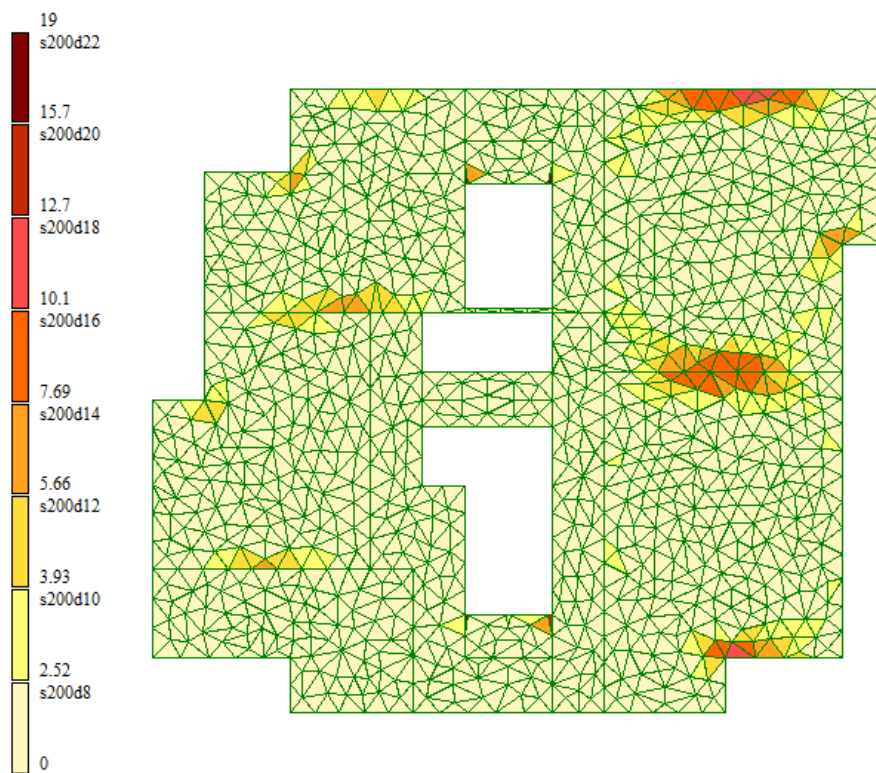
Схема армирования плит перекрытий по оси Y (у верхней грани)
